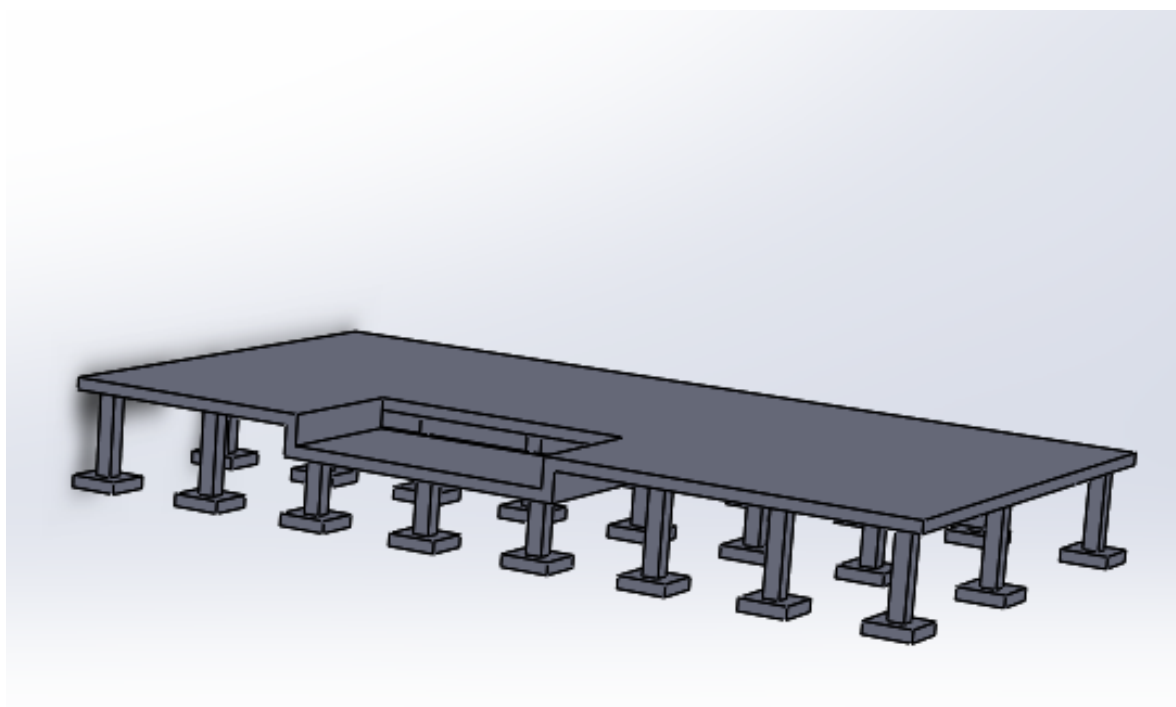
Фундамент 9-ти поверхового будинку
